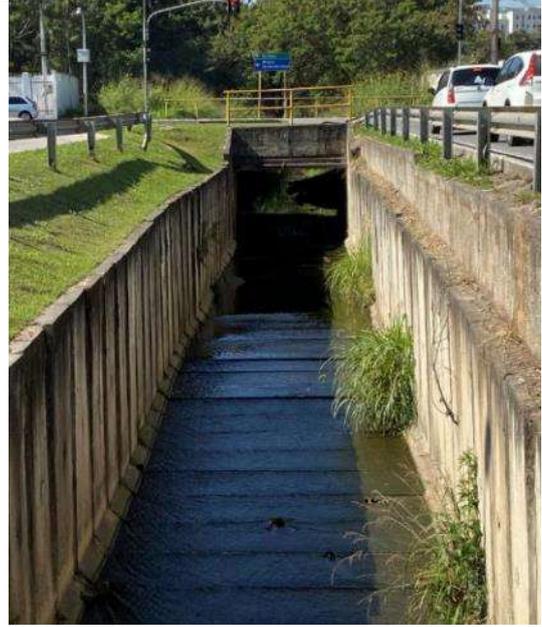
Vista da travessia a jusante – canal de seção retangular a céu aberto entre a Avenida P. Getúlio Vargas e Avenida Davi Lino Monteiro
